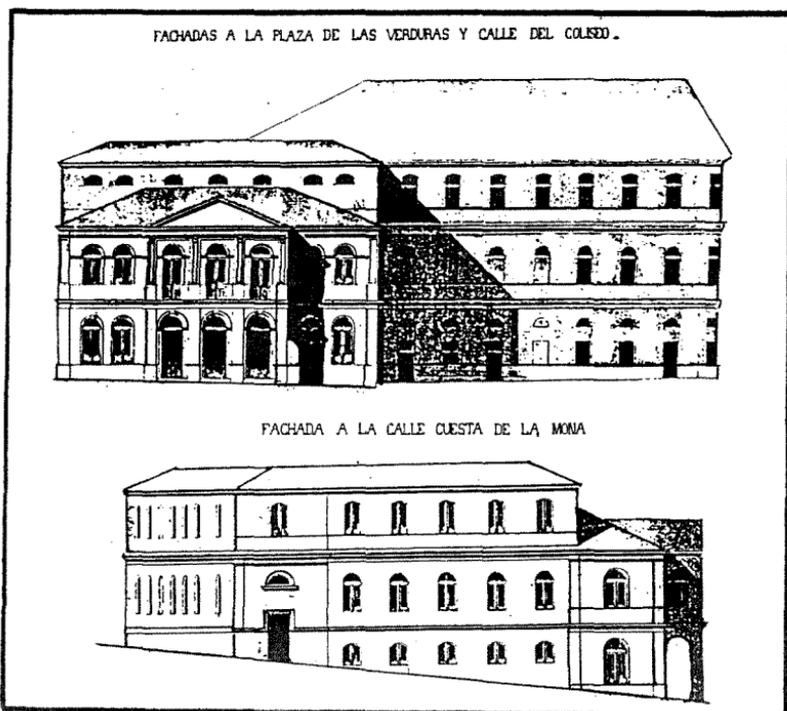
Alzados del futuro teatro según el proyecto de Fenech en 1866 (A.M.T.).
